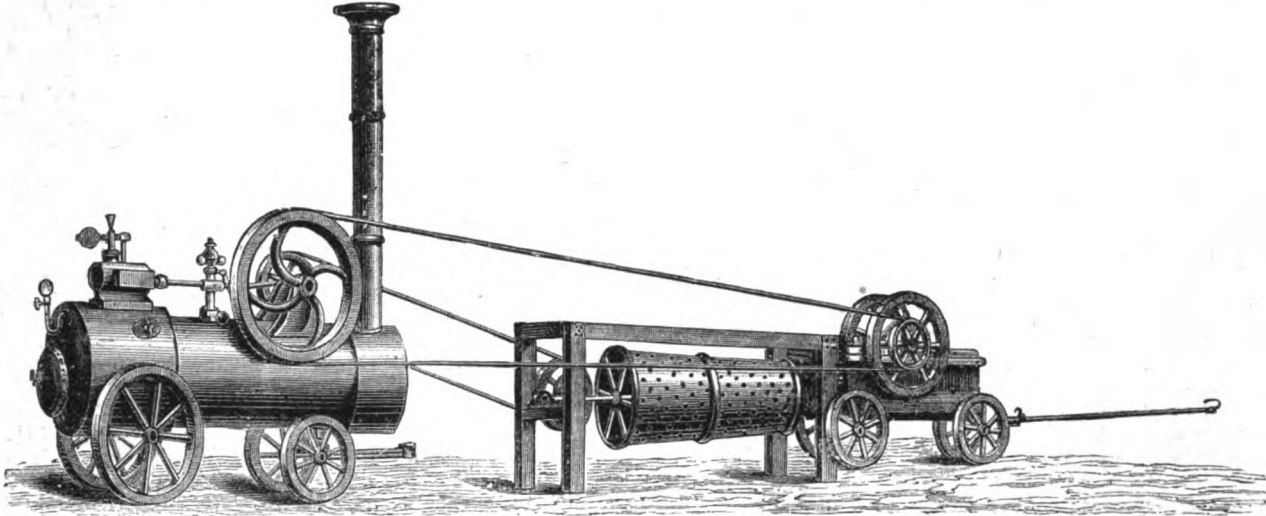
Transportable Steinbrechmaschine für Strassenschotter von H. R. Gläser, Wien.
